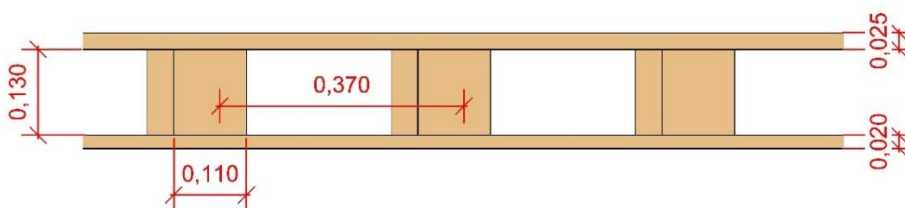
Detalhe da estrutura do pavimento do piso 1
